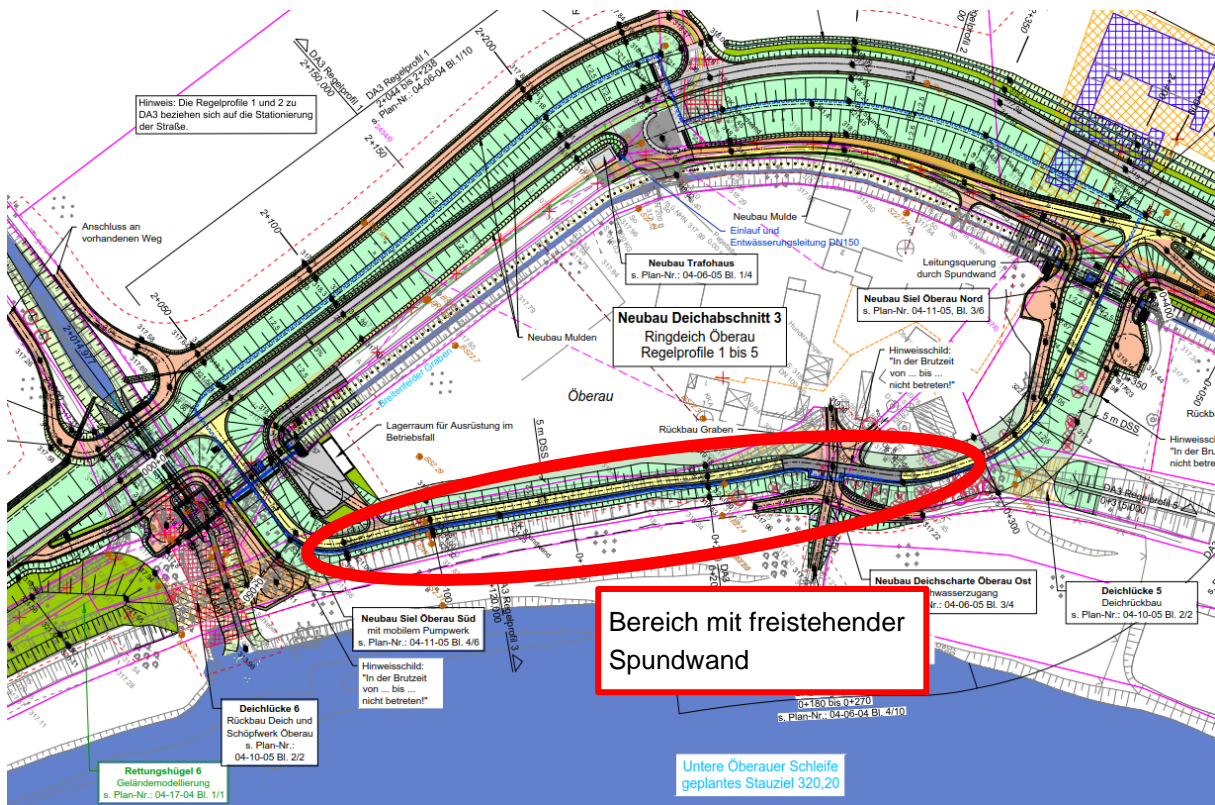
Deichabschnitt 3, Ringdeich Oberau, Lageplan (aus Plan 03-03-03, Blatt 2/3)
